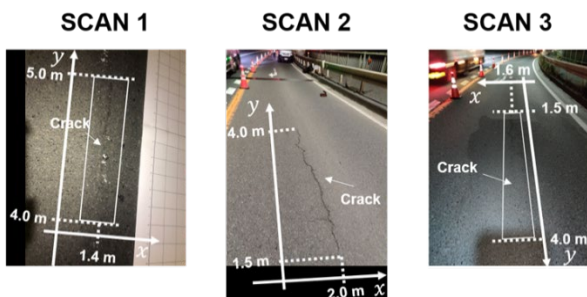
清水橋の測定領域とひび割れの位置
